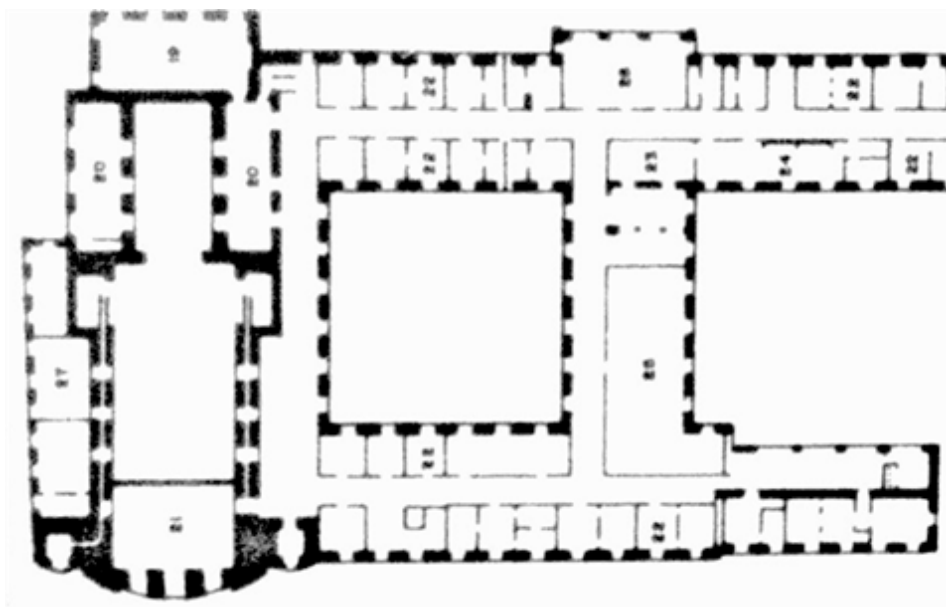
Igreja e Convento das mercês, Belém, Pará, planta baixa.
